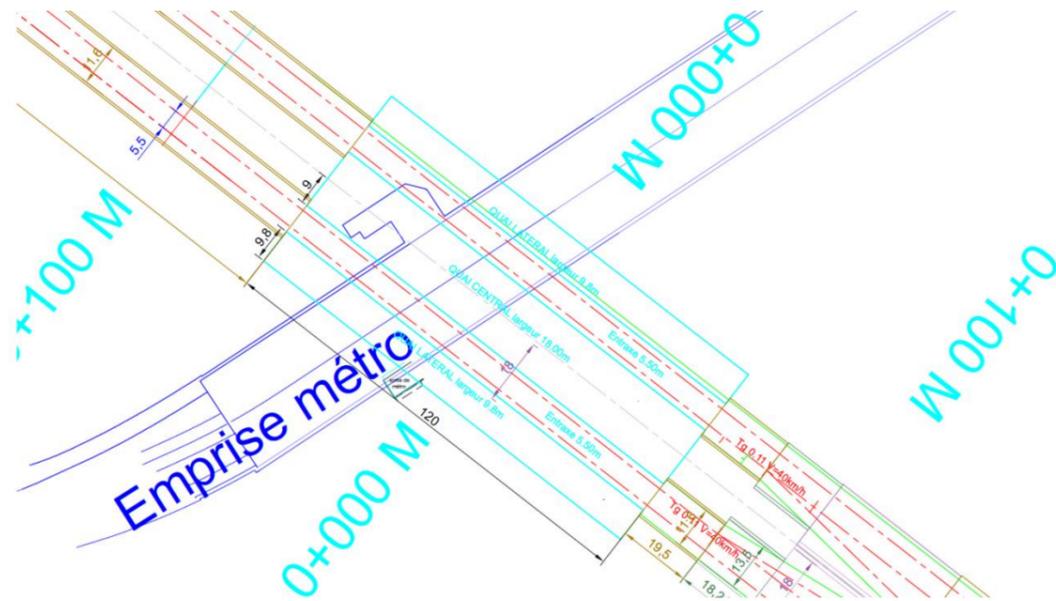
Vue en plan du génie civil du corps principal de la gare
